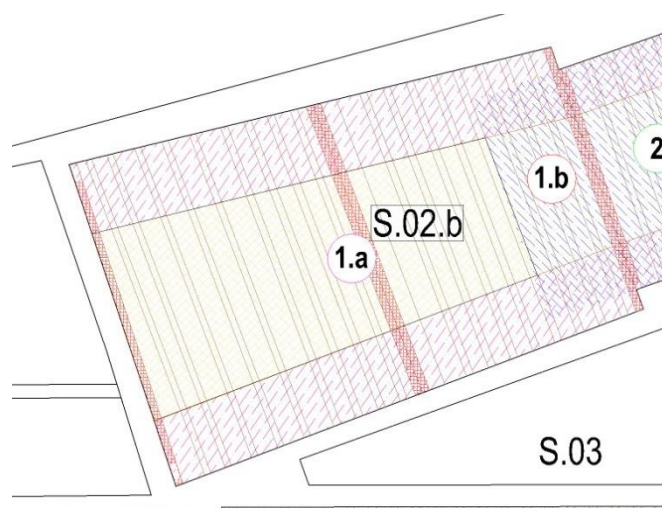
Pianta strutture controsoffitto vano S.02.b
